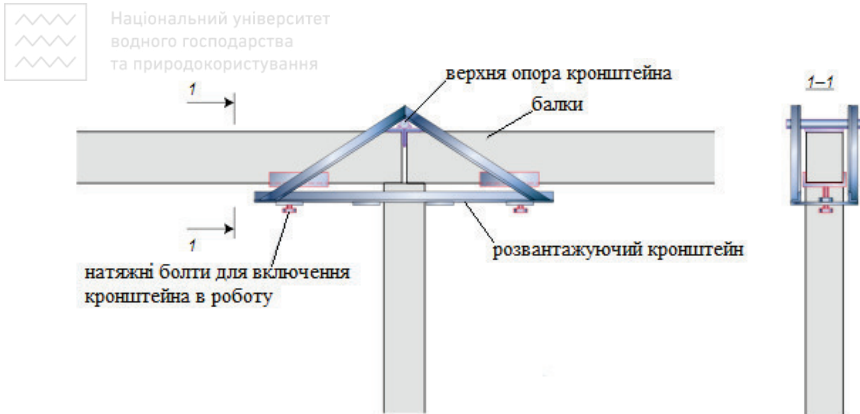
Підсилення залізобетонних балок кронштейнами
